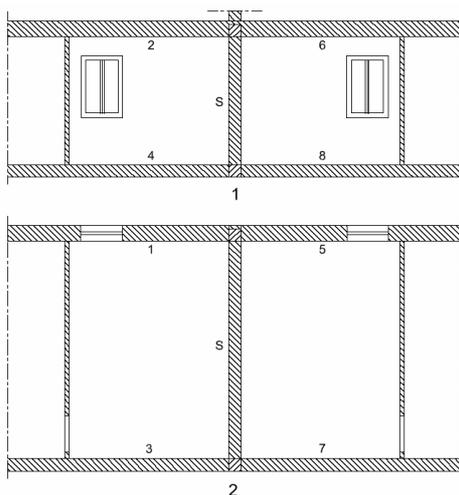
Codifica degli elementi strutturali dei due ambienti in pianta e sezione
